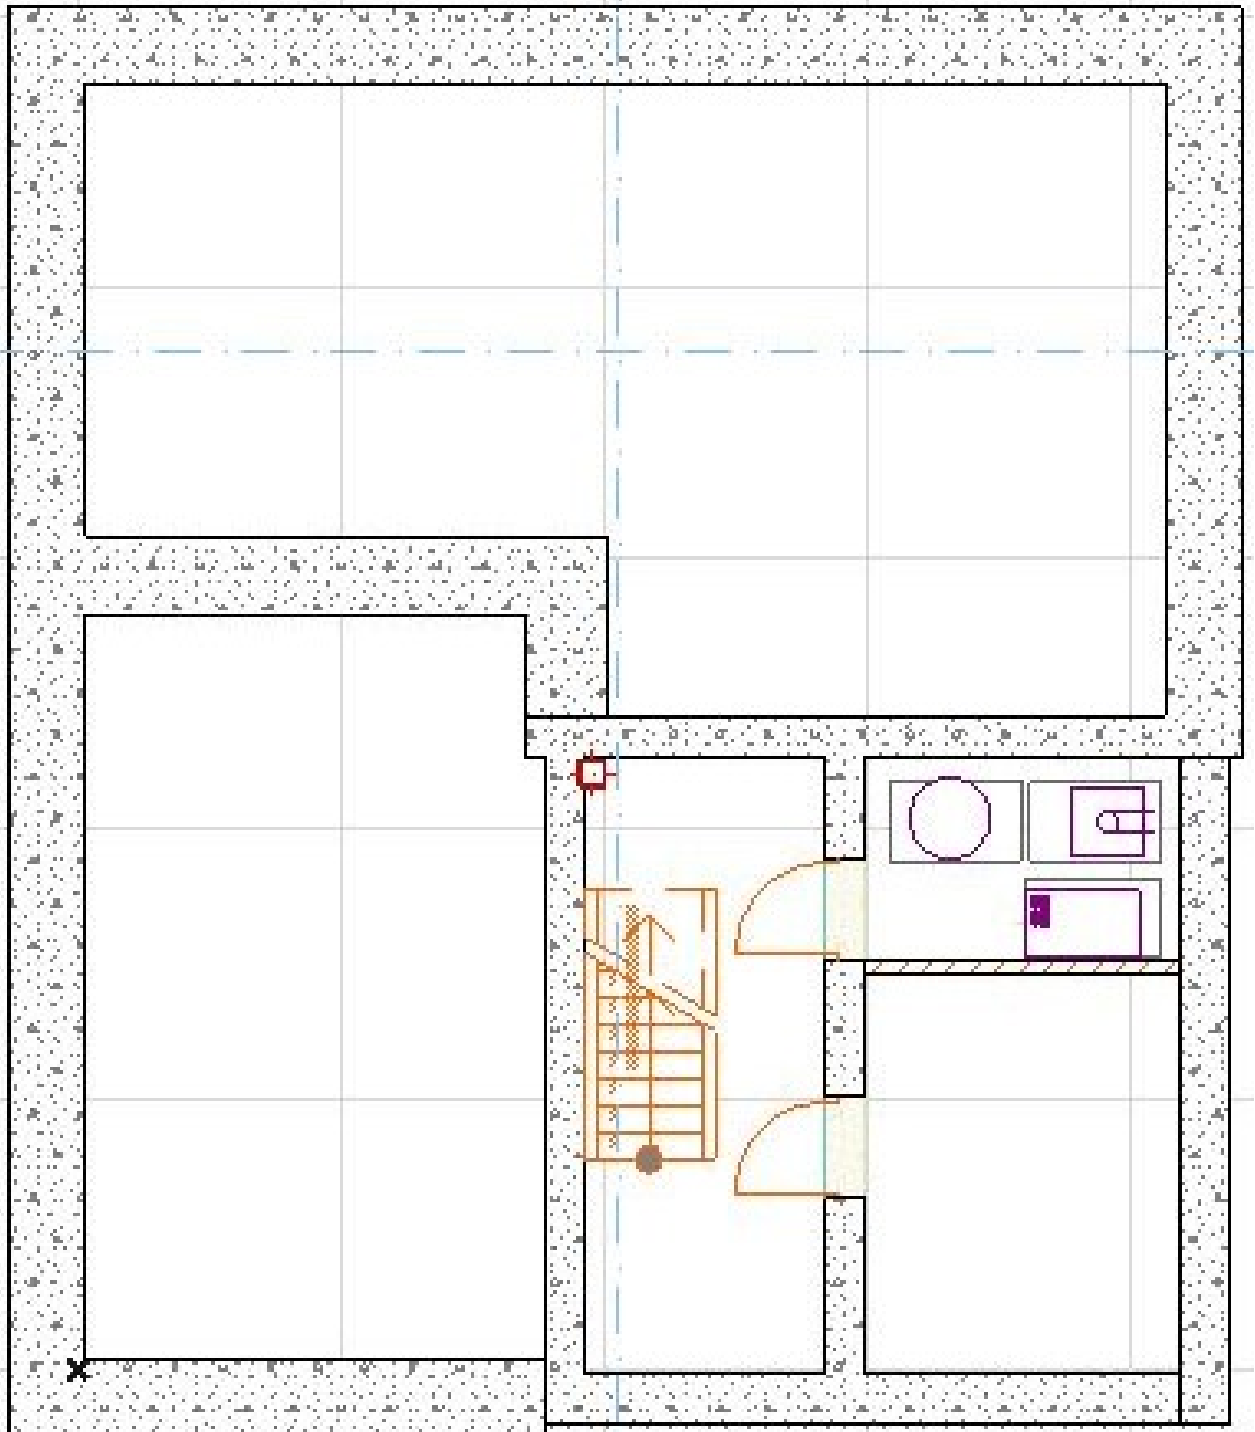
План підвалу (на рівні подушки фундаменту)
